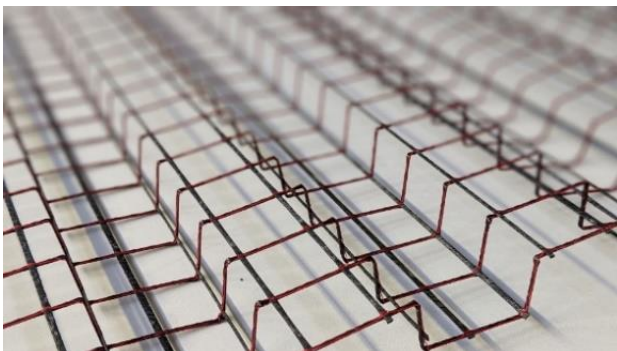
Textile Bewehrung – umgeformte Gitterstruktur
